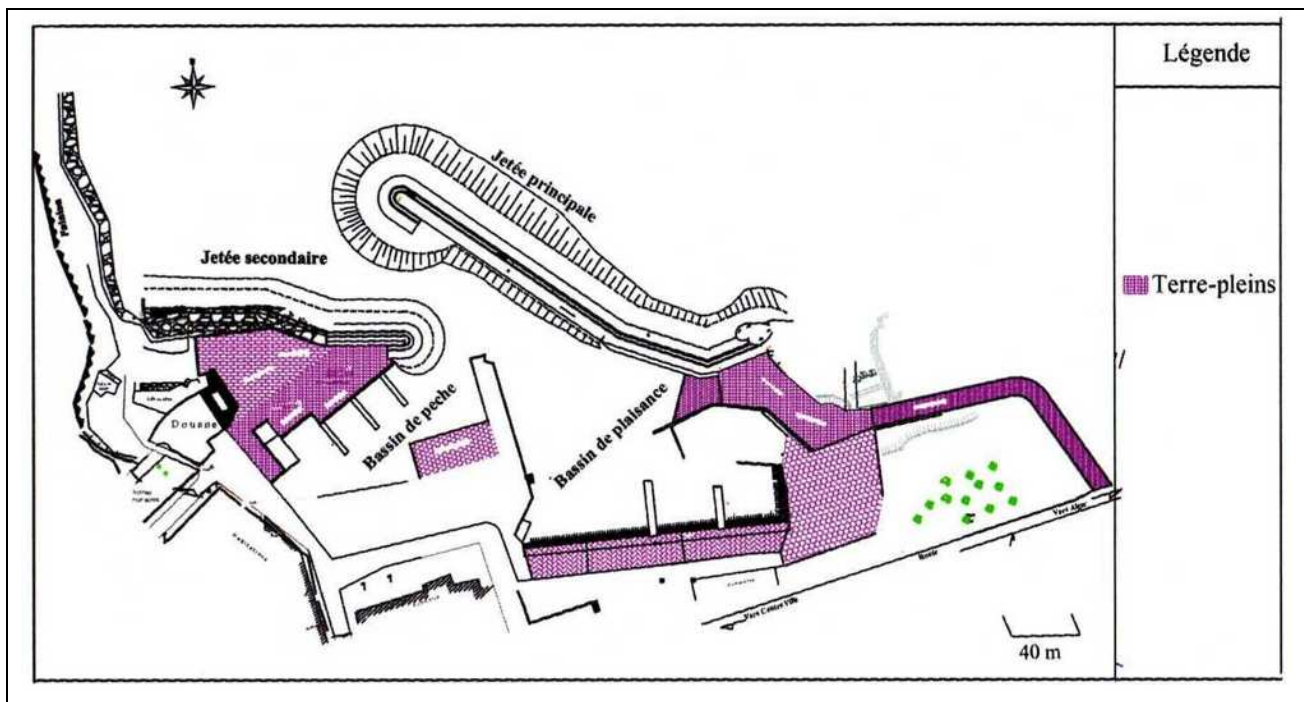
plan de revêtement des terres pleins dans le port de Tipaza.
